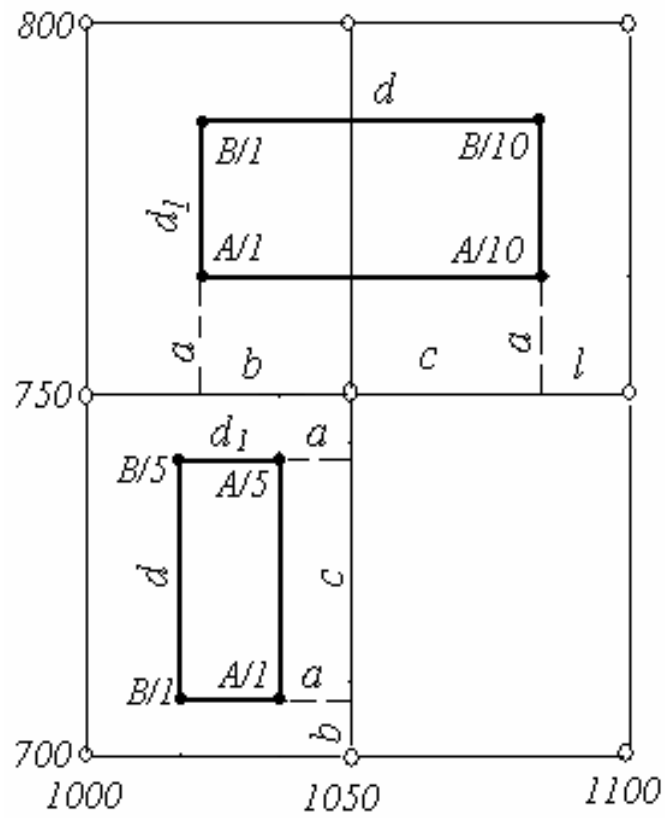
Розмічувальне креслення прив'язки проекту будівель до пунктів будівельної сітки
